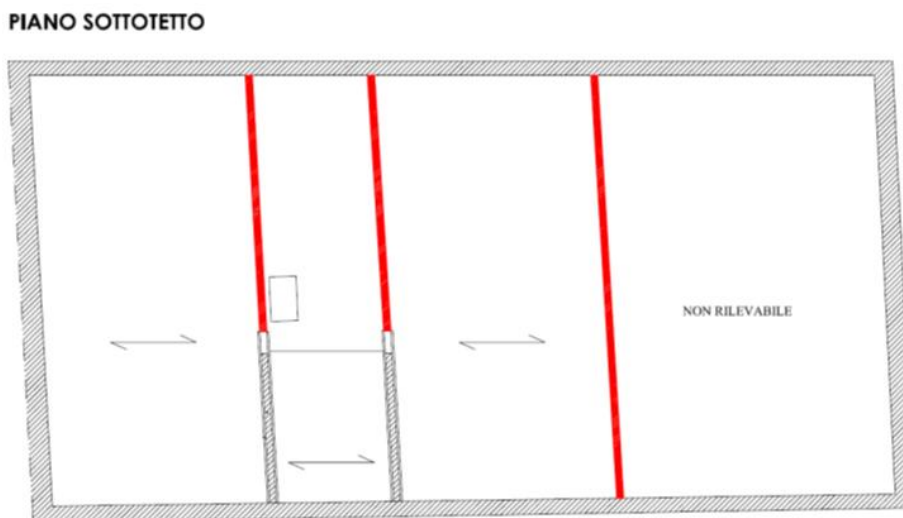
Pareti con funzione strutturale nel sottotetto
